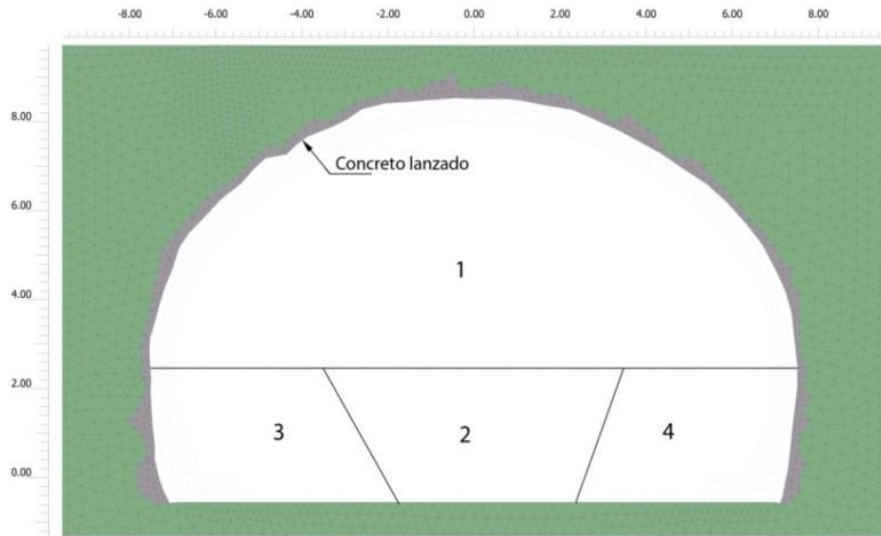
Detalle de la malla de elementos finitos en la zona del túnel.
